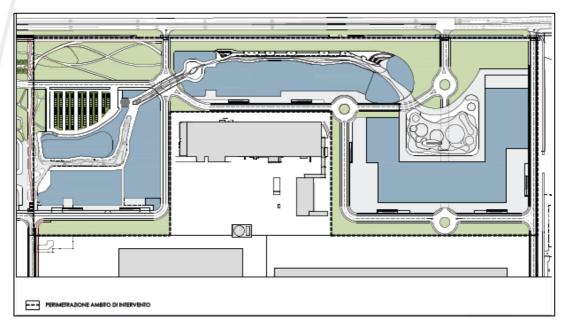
Tipologie edilizie indicative – Planimetria generale di progetto
